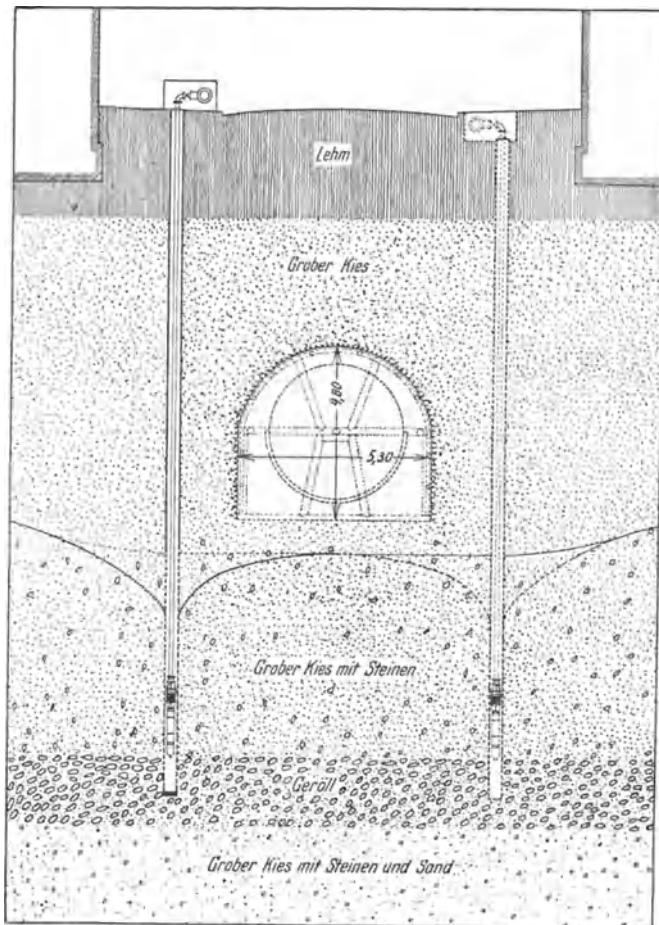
Ausführung im Tunnelbau mit Grundwasserabsenkung¹.
